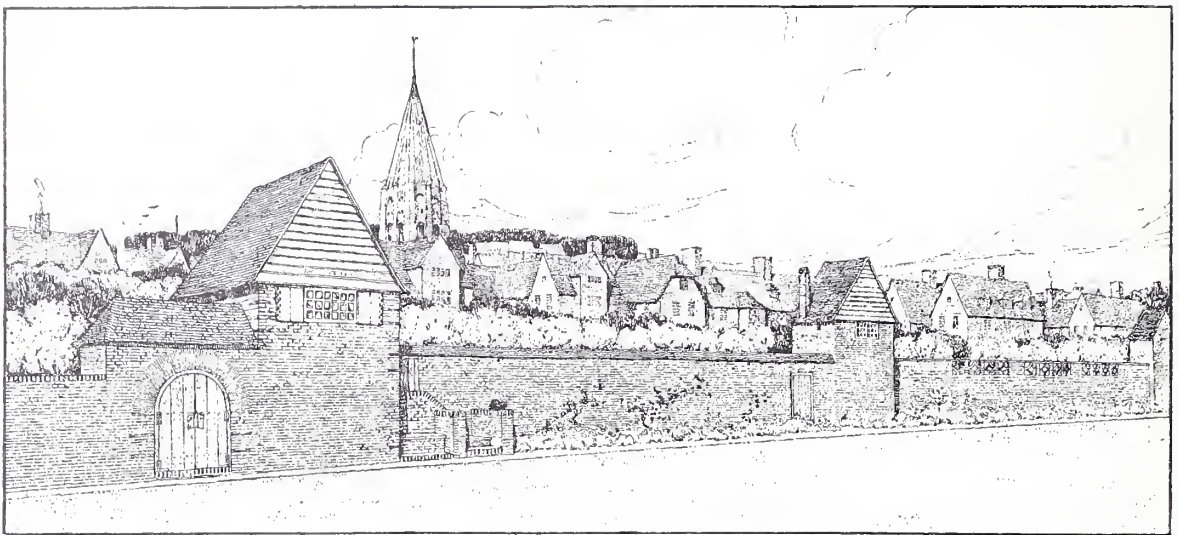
Garden Suburb Hampstead. Projektierter Abschluß des bebauten Terrainabschnittes gegen die Hügel von Hampstead Heath (siehe Abb. 4, Plan 9)
